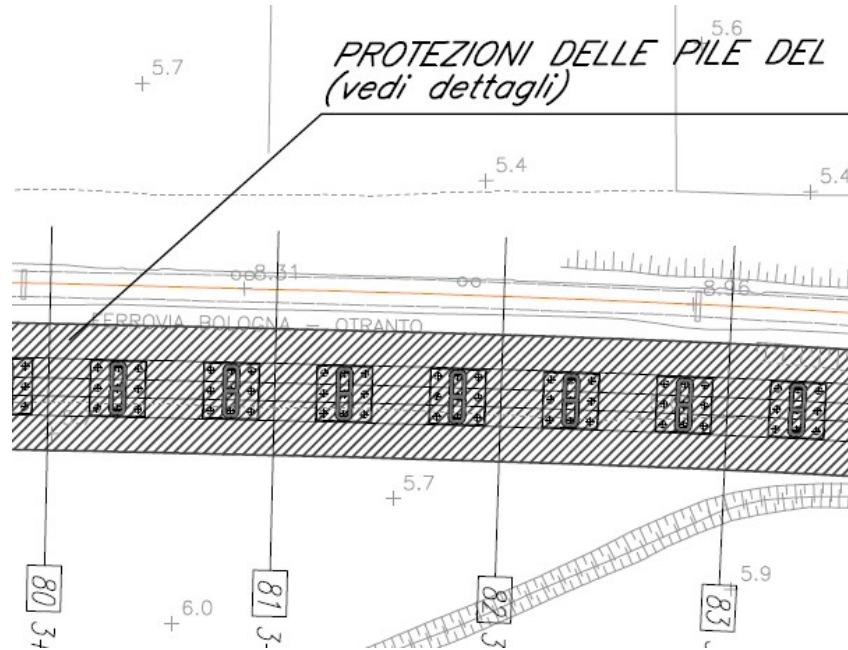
Protezioni al piede delle pile - stralcio planimetrico.
